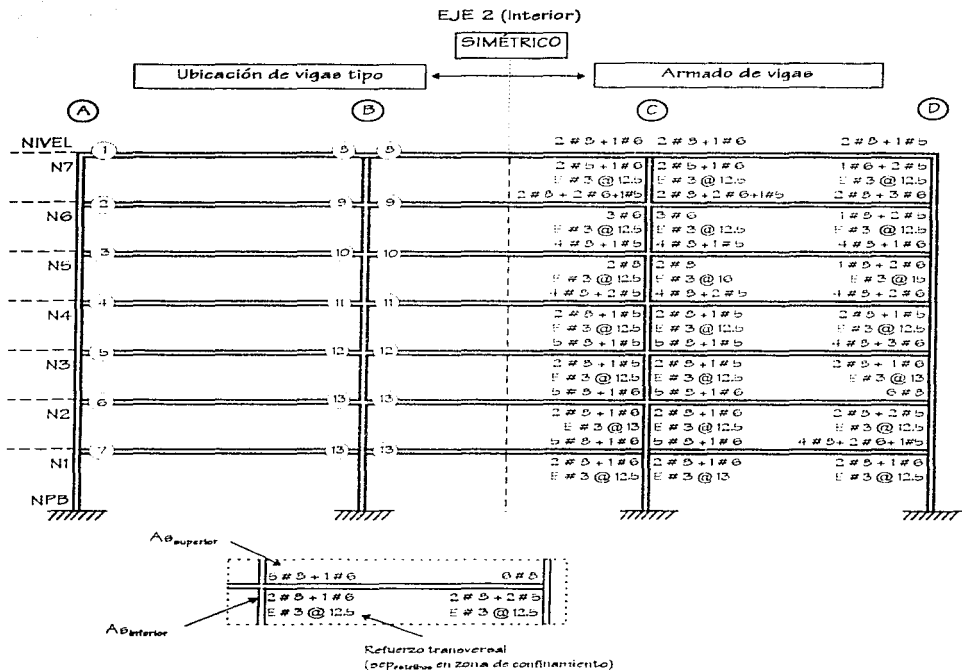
Ubicación de tipos de armados de vigas del eje 2 de la estructura diseñada en la zona II
